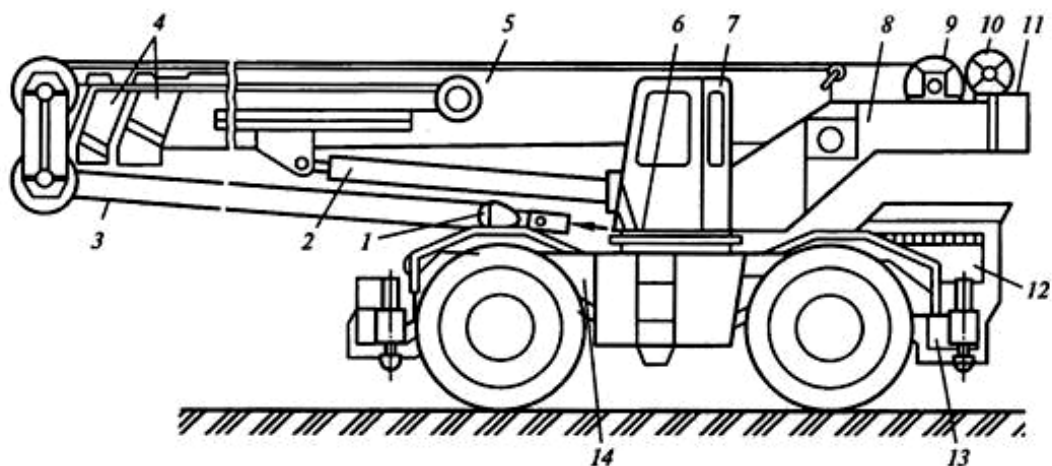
Пневмоколесный кран на короткобазовом шасси: 1 – крюковая подвеска; 2 – гидроцилиндр; 3 – грузовой полиспаст; 4 – секции стрелы; 5 – стрела; 6 – опорно-поворотное устройство; 7 – кабина управления; 8 – поворотная рама; 9 – лебедка грузовая; 10 – вспомогательная лебедка; 11 – противовес; 12 – дизельная установка; 13 – выносные опоры; 14 – ходовая рама
